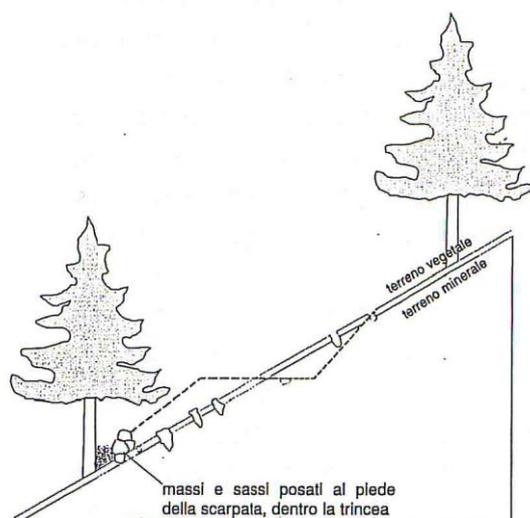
Posizionamento di massi e pietre al piede del rilevato per la formazione del muro d'unghia⁶
